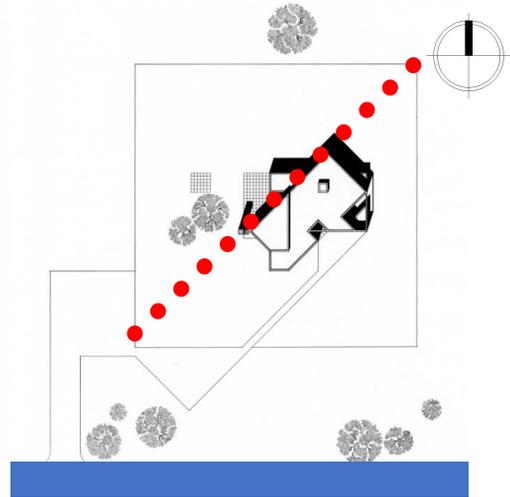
Planta Casa Hoffman Consultada en: <http://www.richardmeier.com/?projects=hoffman-house>
